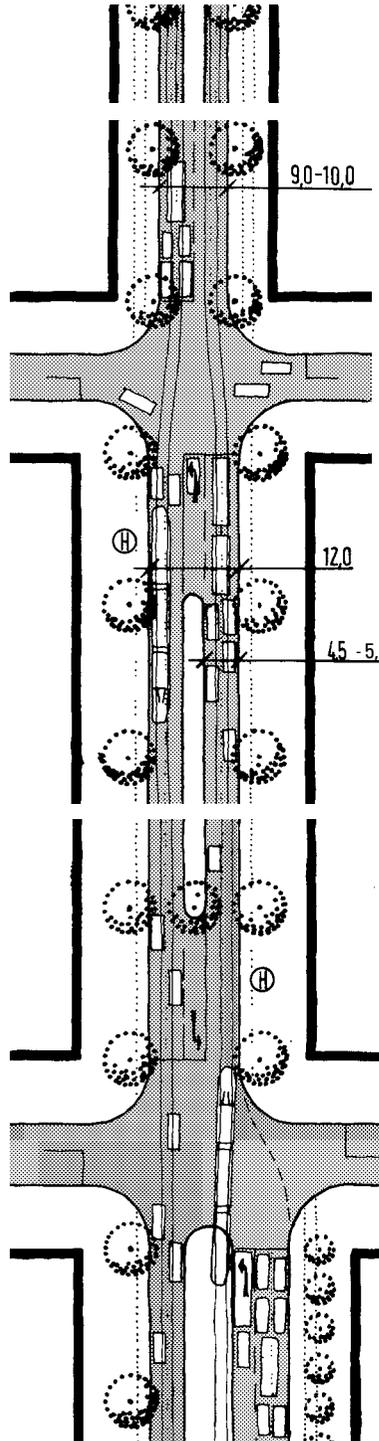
Städtische Hauptverkehrsstraßen mit flächensparendem ÖV-Vorrang - Prinzipskizzen Grundriss
